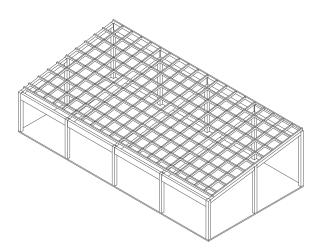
Axonometría estructural tipo 1_6 Fuente: Autores, 2024
